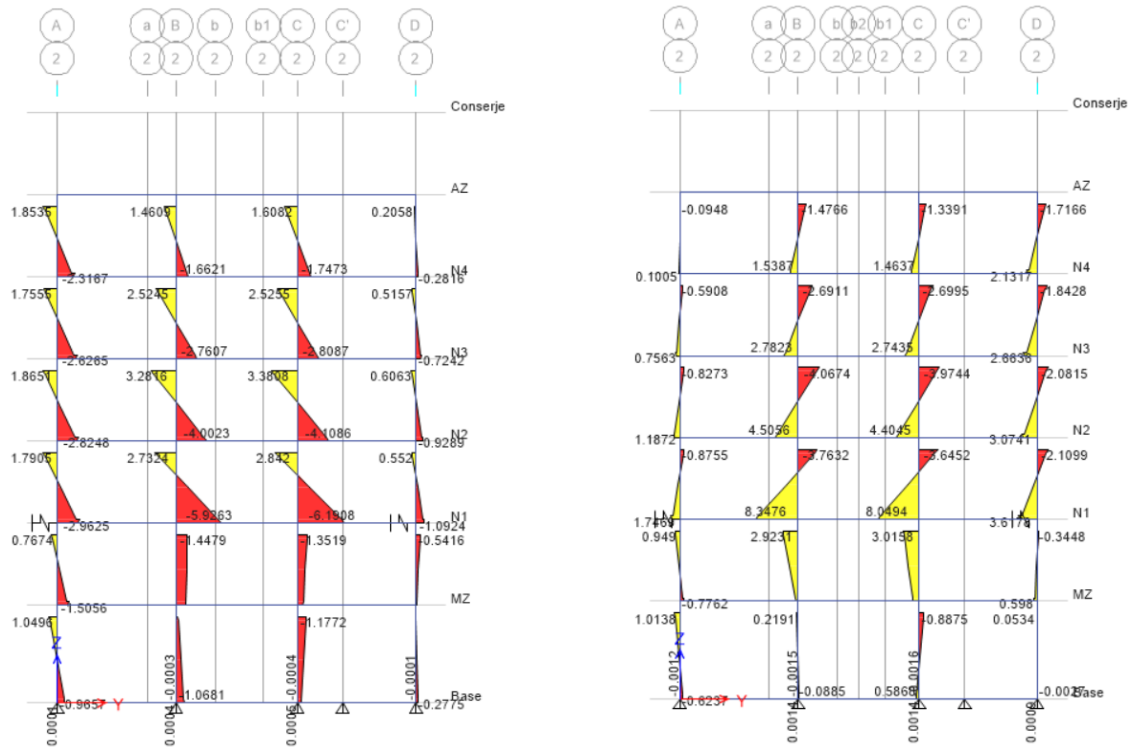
Esfuerzos de momento en columnas elevación 2. Modelos F y G respectivamente.
